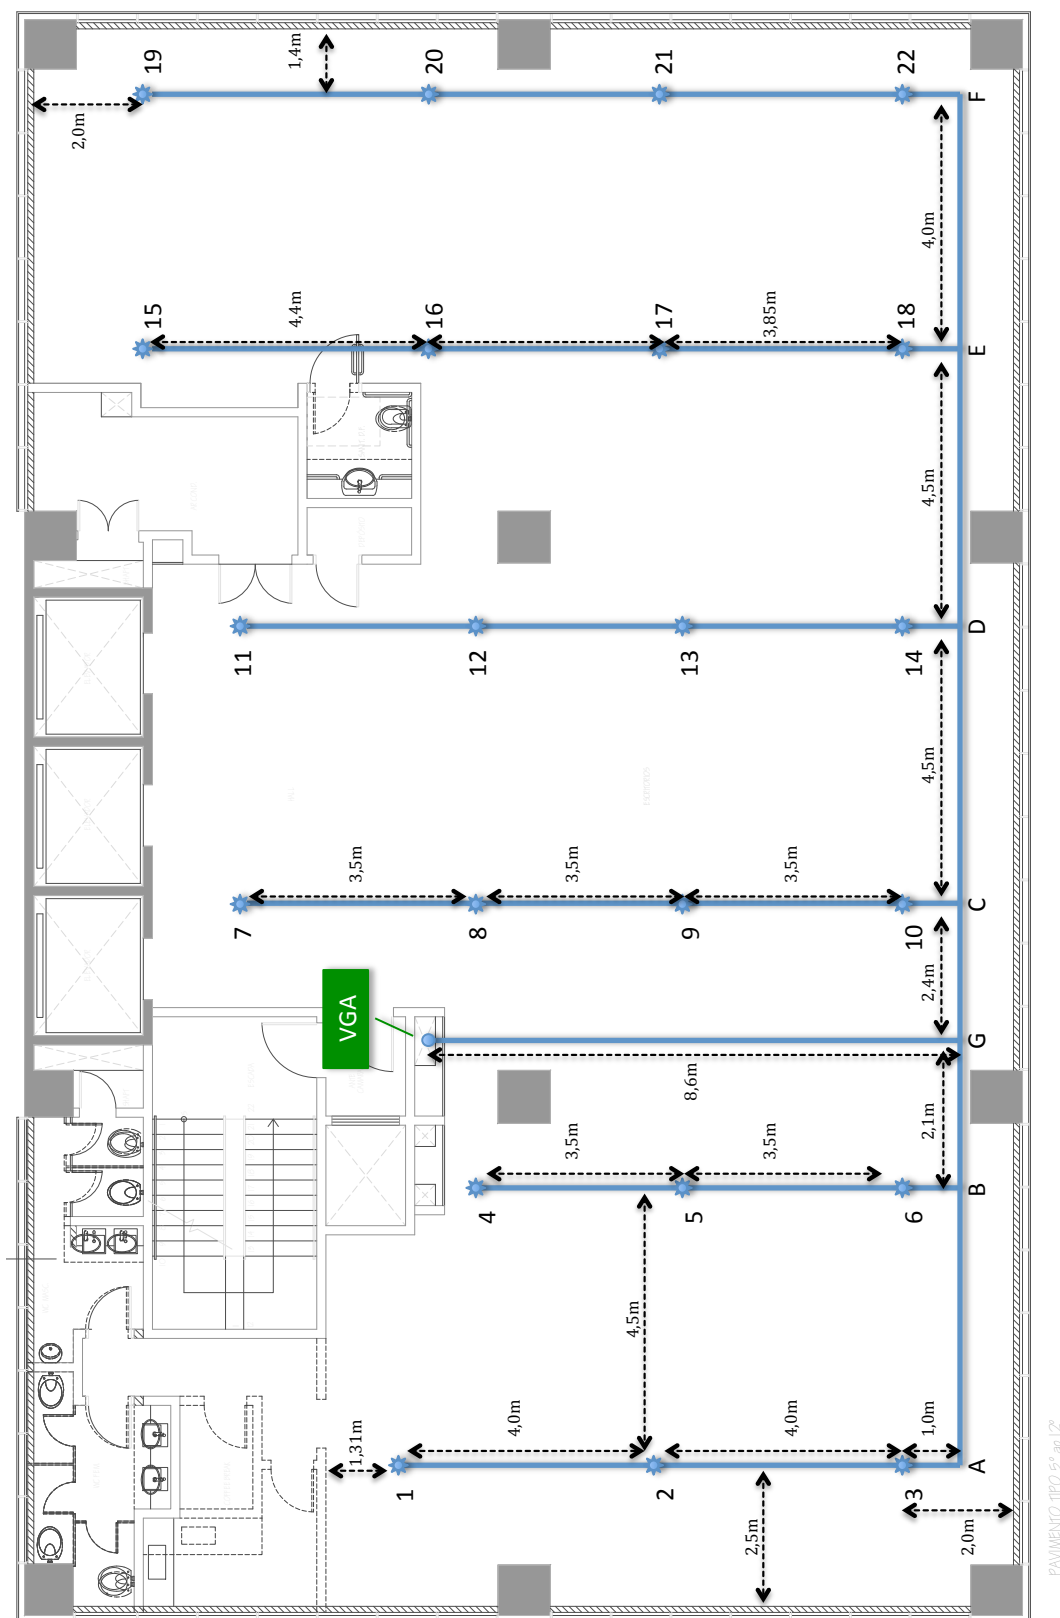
Planta de distribuição de sprinklers dos andares 4 ao 13
